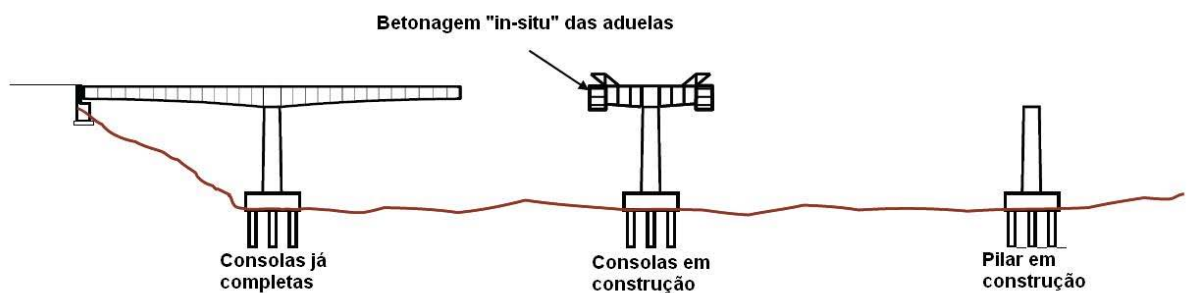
Esquemática da construção por avanços sucessivos, com aduelas betonadas *in-situ*.
